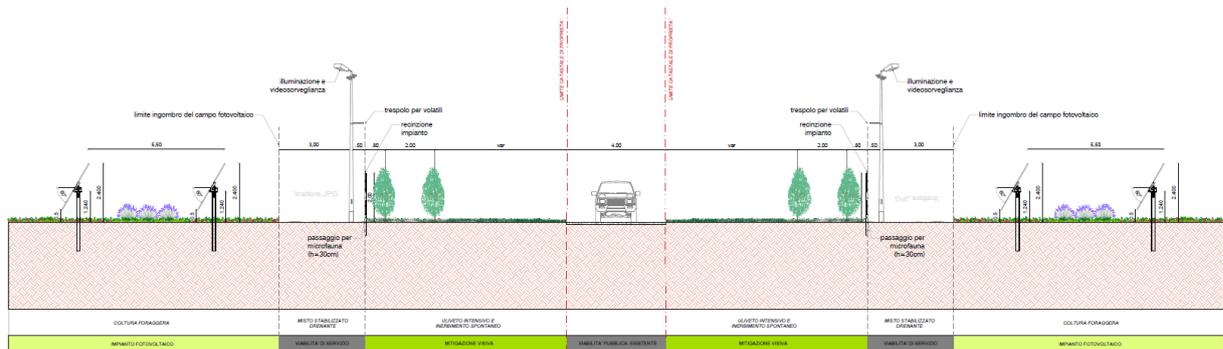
Sezione 2_Prospetto fascia di mitigazione in prossimità della viabilità esistente
